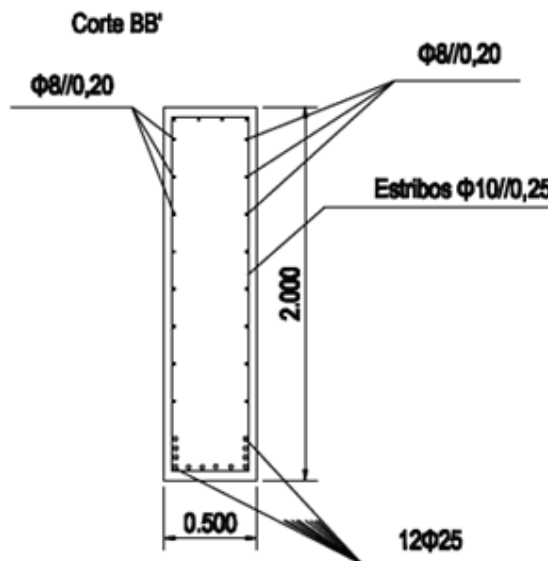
Corte BB' da viga-parede, modelo alternativo.
